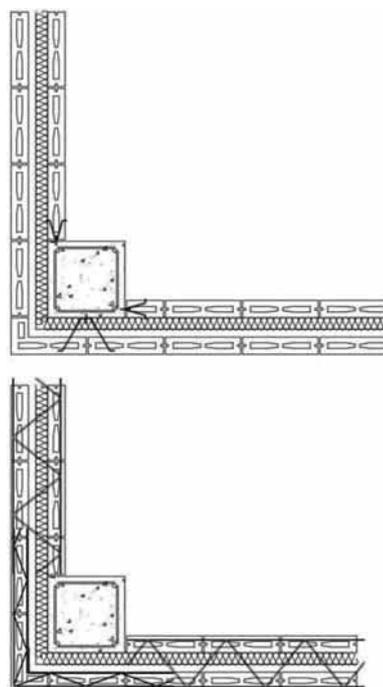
Plantas de encuentros de muro de cerramiento de 2 hojas (DCW), con cámara de aire y aislamiento, con pilares en esquina: hiladas pares, hiladas impares.
